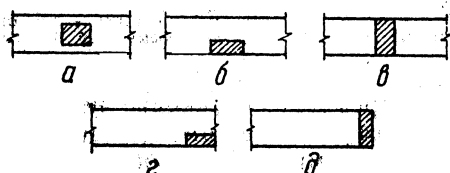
Схемы приложения нагрузок при расчете на местное сжатие:
